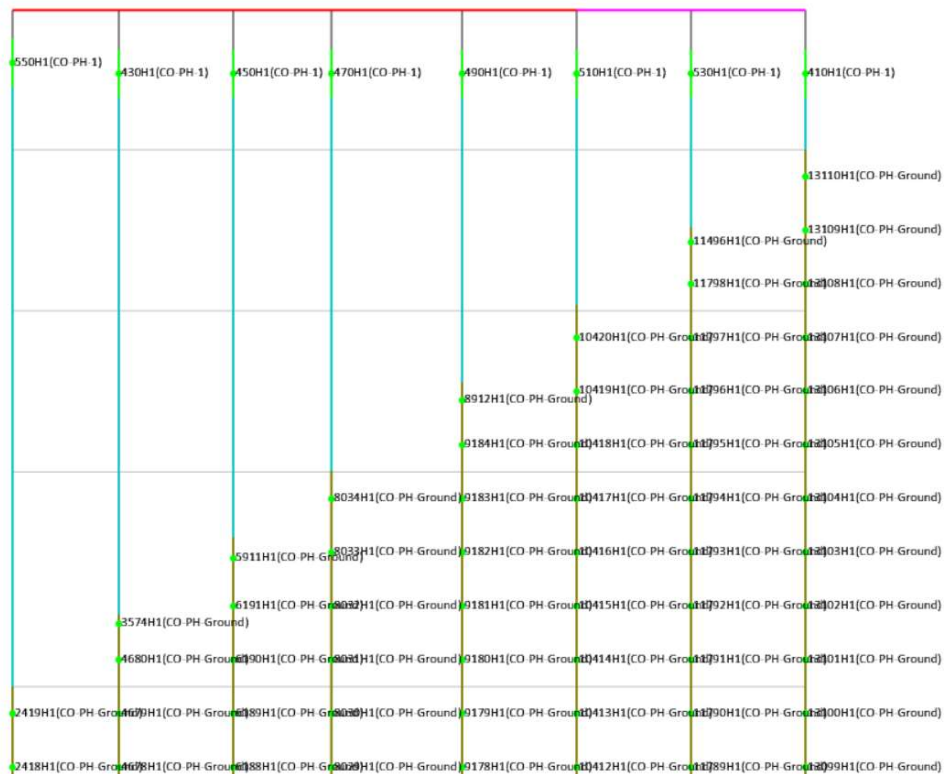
Rótulas plásticas en la parte superior e inferior de los pilotes verticales
